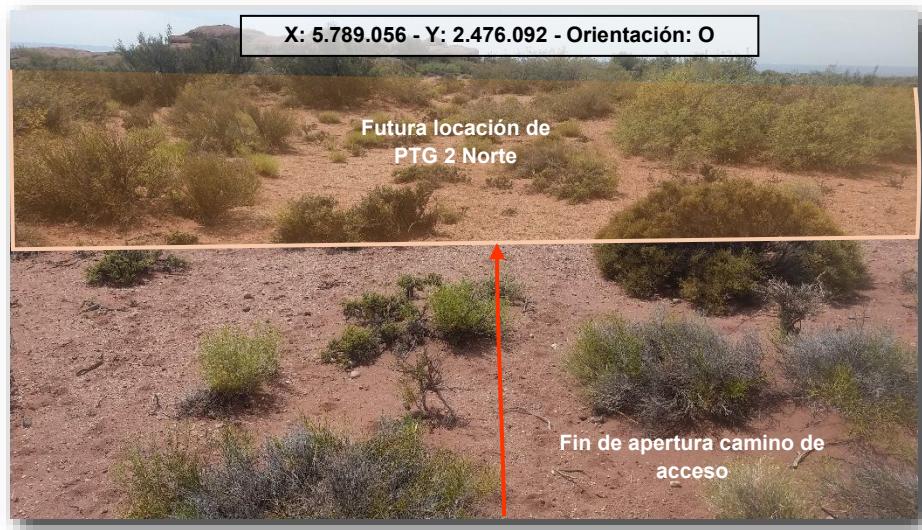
Llegada del camino de acceso a la futura locación PTG 2 Norte.
